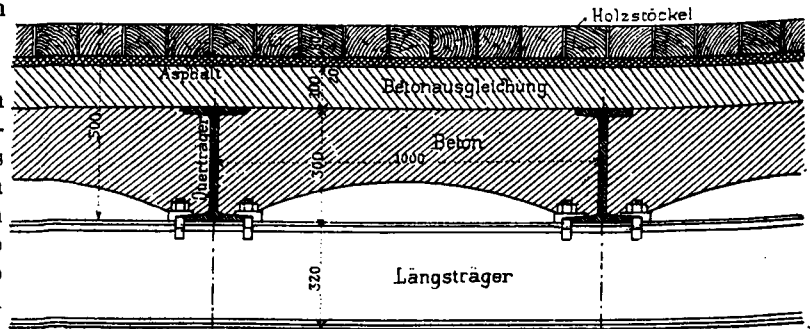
Längenschnitt durch die Deckenconstruction in der Tunnelmitte bei Holzpflaster.
